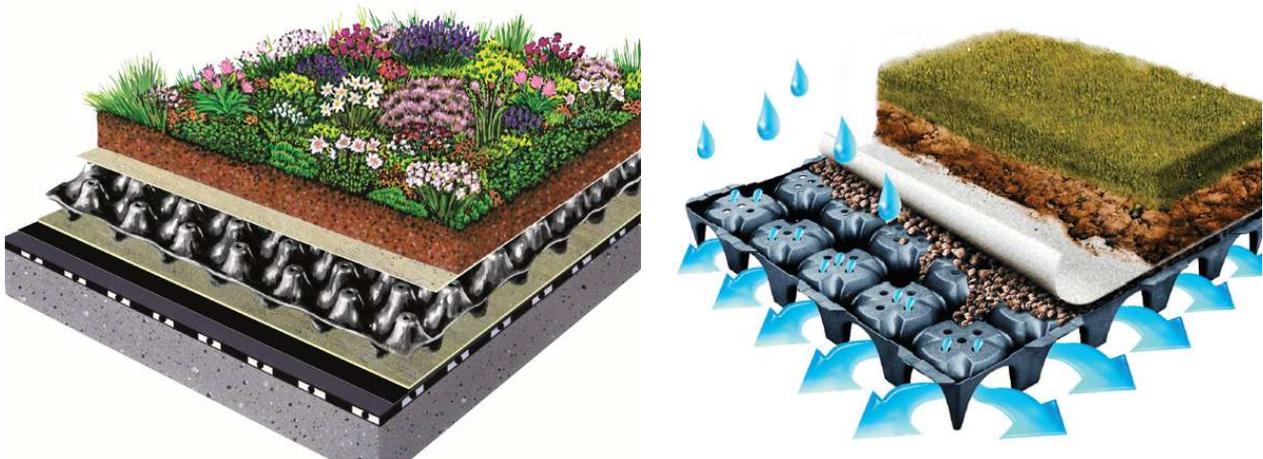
Stratigrafia tipo (a sinistra) e sistema di filtraggio e drenaggio (a destra) di un tetto giardino di tipo estensivo
